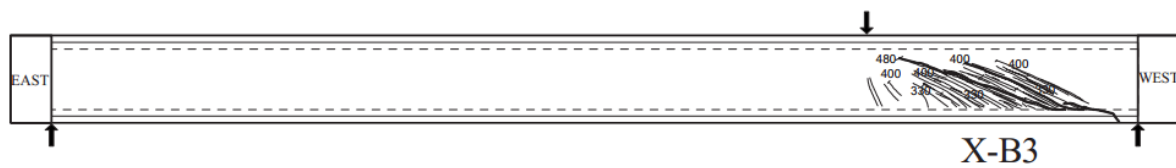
Croquis de fissuration de la poutre en I
